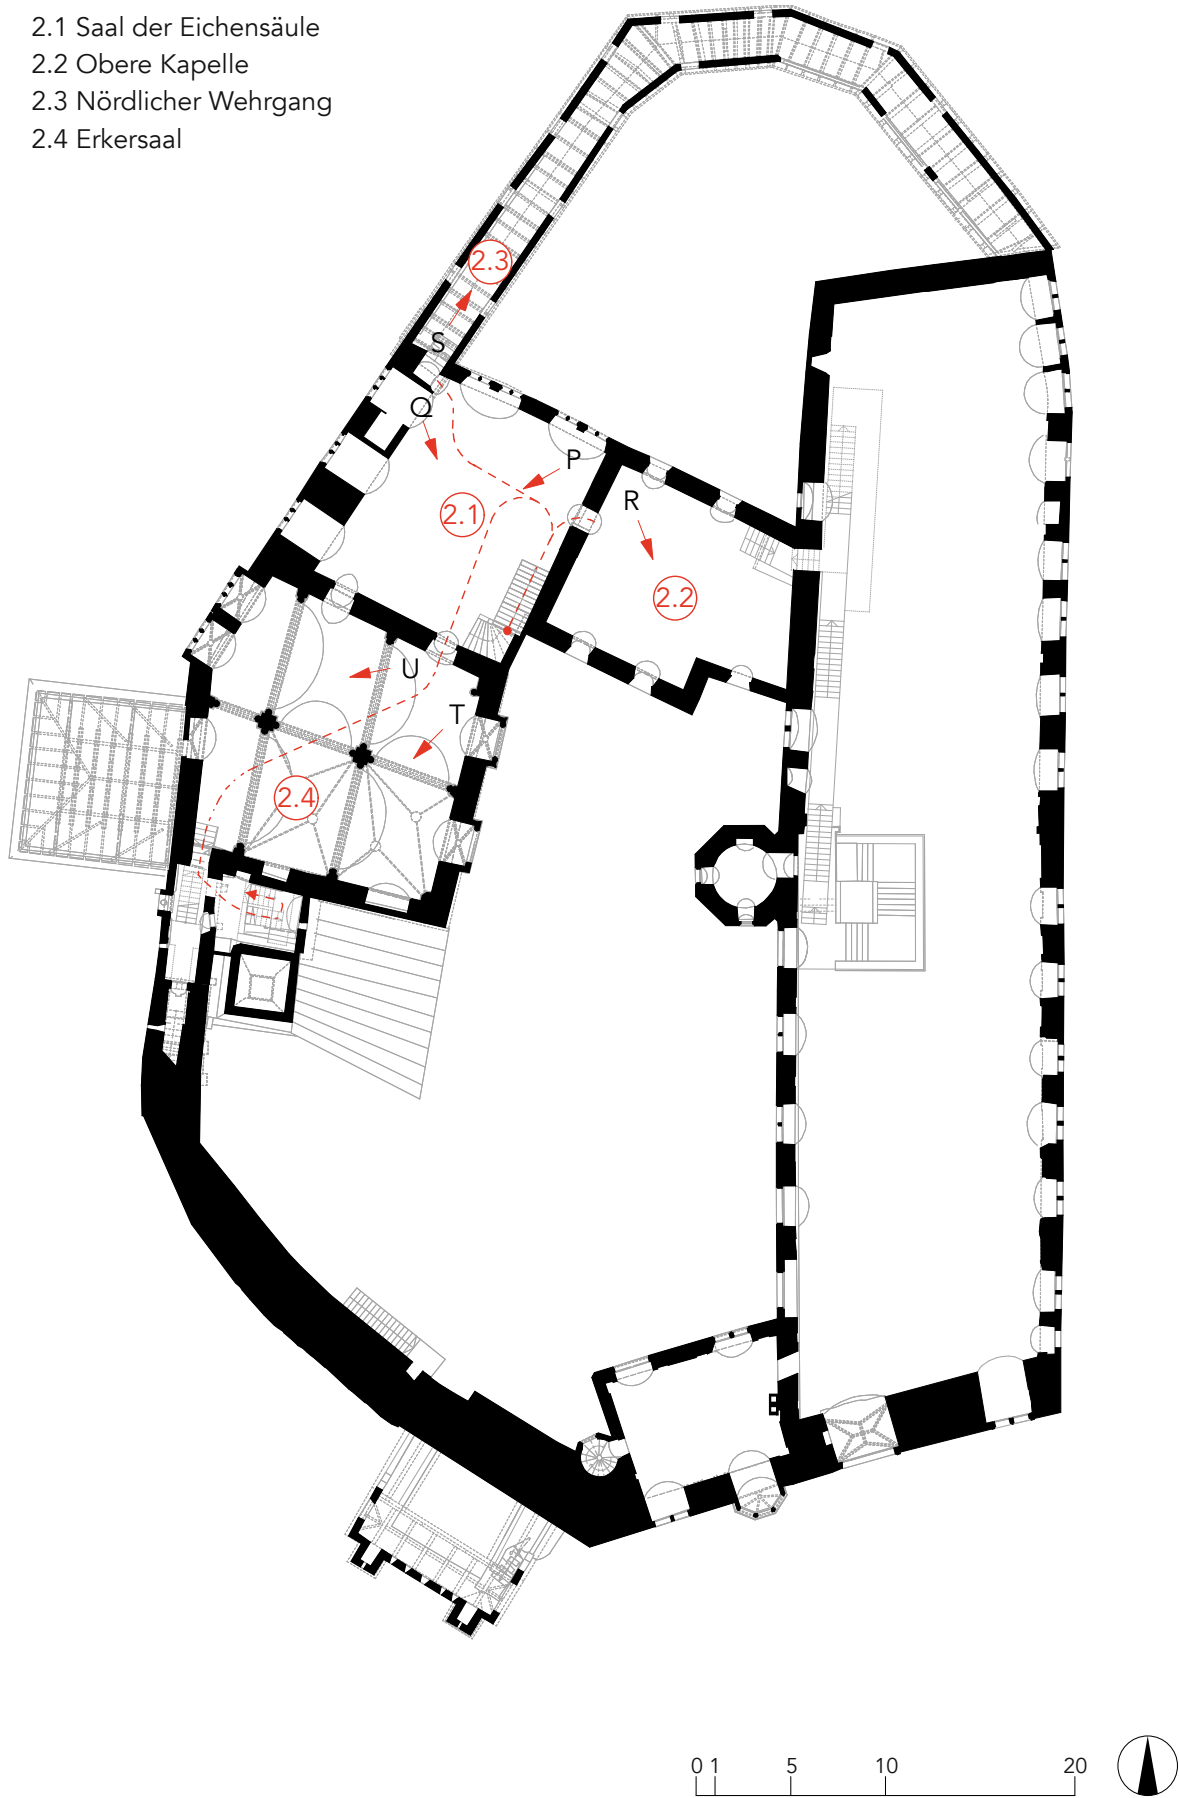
Grundriss 2.Obergeschoss der Kernburg, gezeichnet von Verfasser nach Plan von Architekten BDA Claus + Forster
